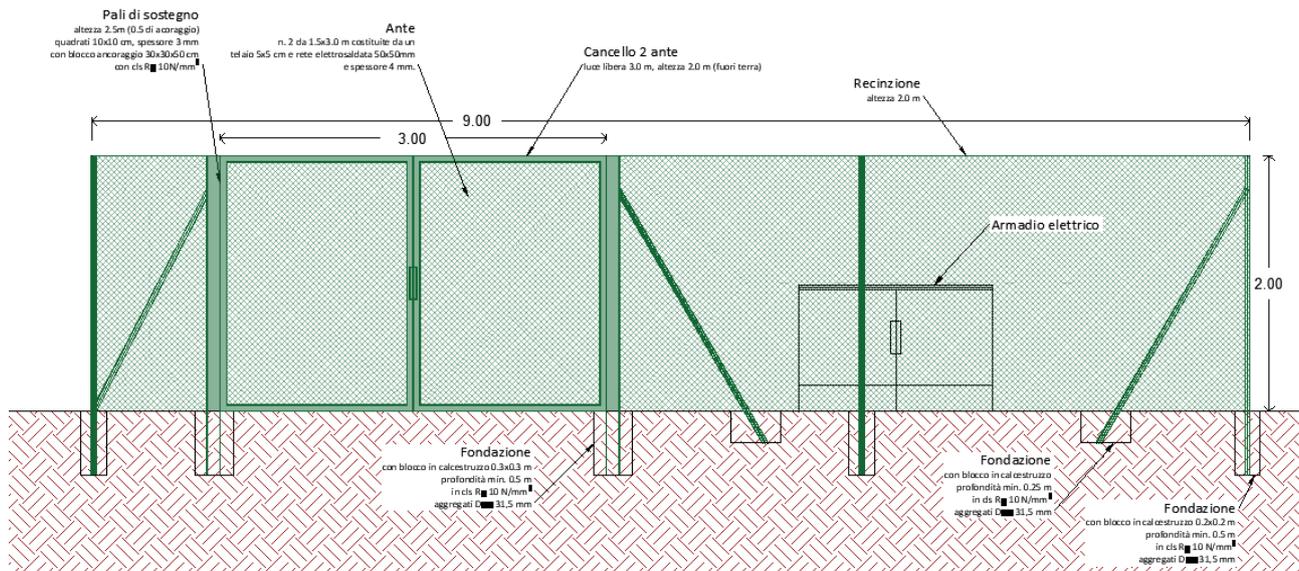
Vista ingresso recinzione (sezione A-A, estratto ET_TAV09)
